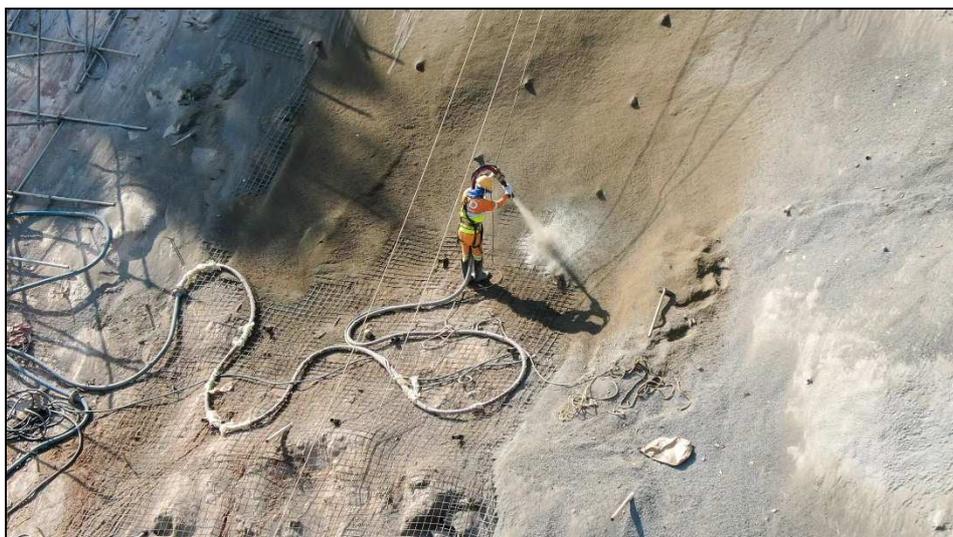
Execução de Concreto Projetado em 04/09/2020.
